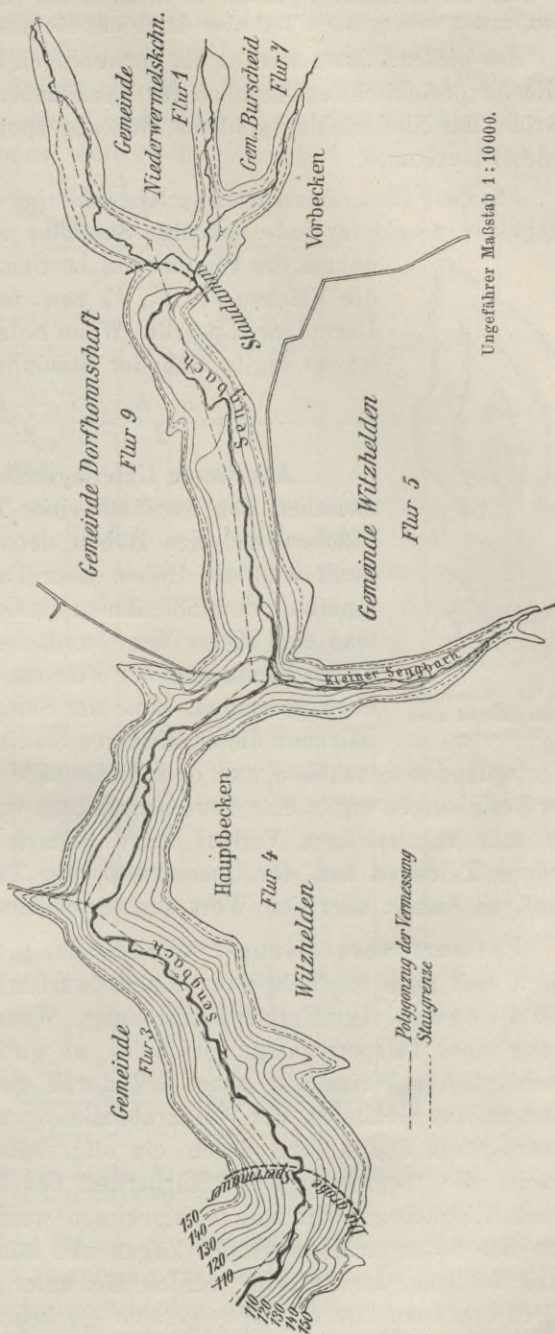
Höhengichtenplan des Sengbachtals bei Solingen. Die Höhenangaben beziehen sich auf NN. und sind durch ein Fein-Nivellement an die Höhenbolzen der Landesaufnahme angeschlossen.
